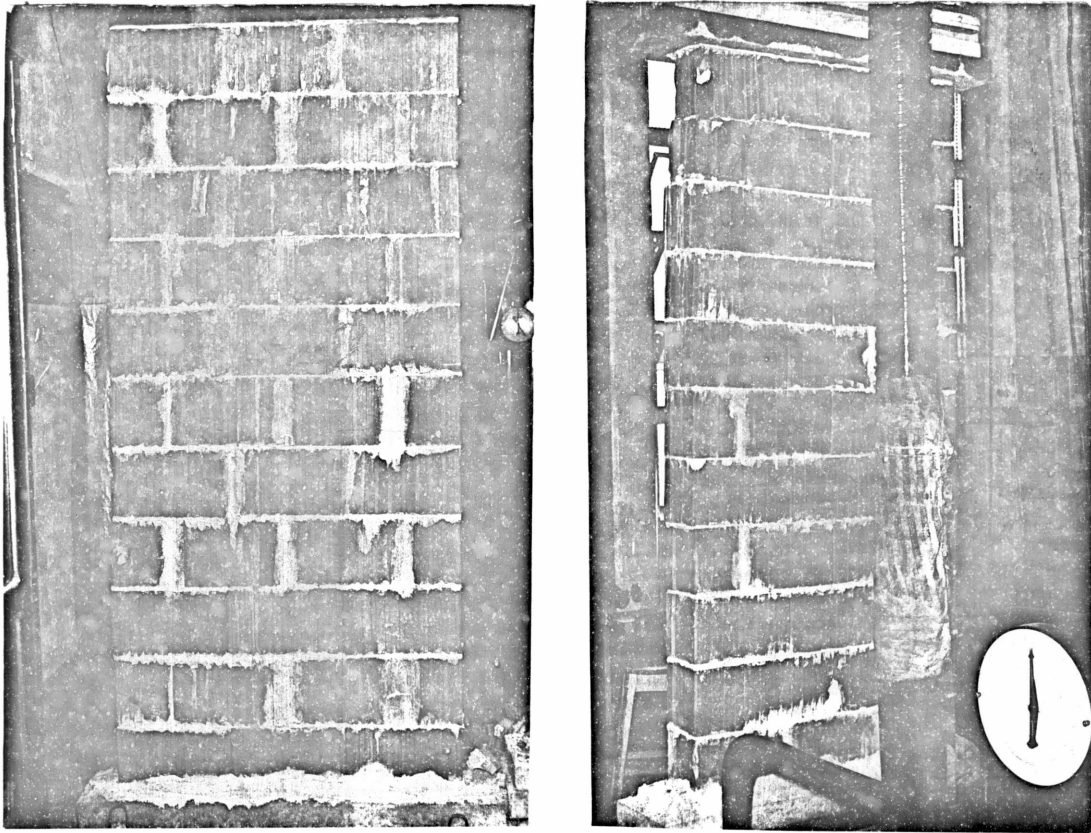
y 17.- Detalles de rotura, bloque tipo B-2
